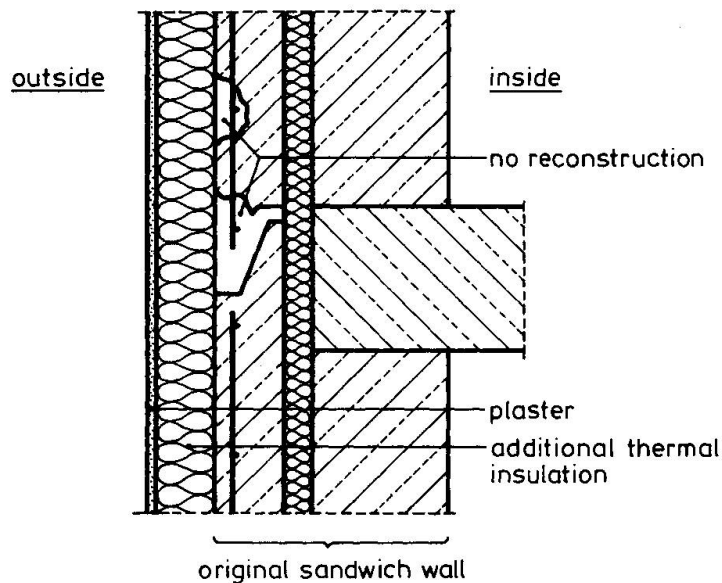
Stahlbetonaußenwand ohne konventionelle Betoninstandsetzung, aber mit nachträglich aufgebrachtem Wärmedämmverbundsystem
